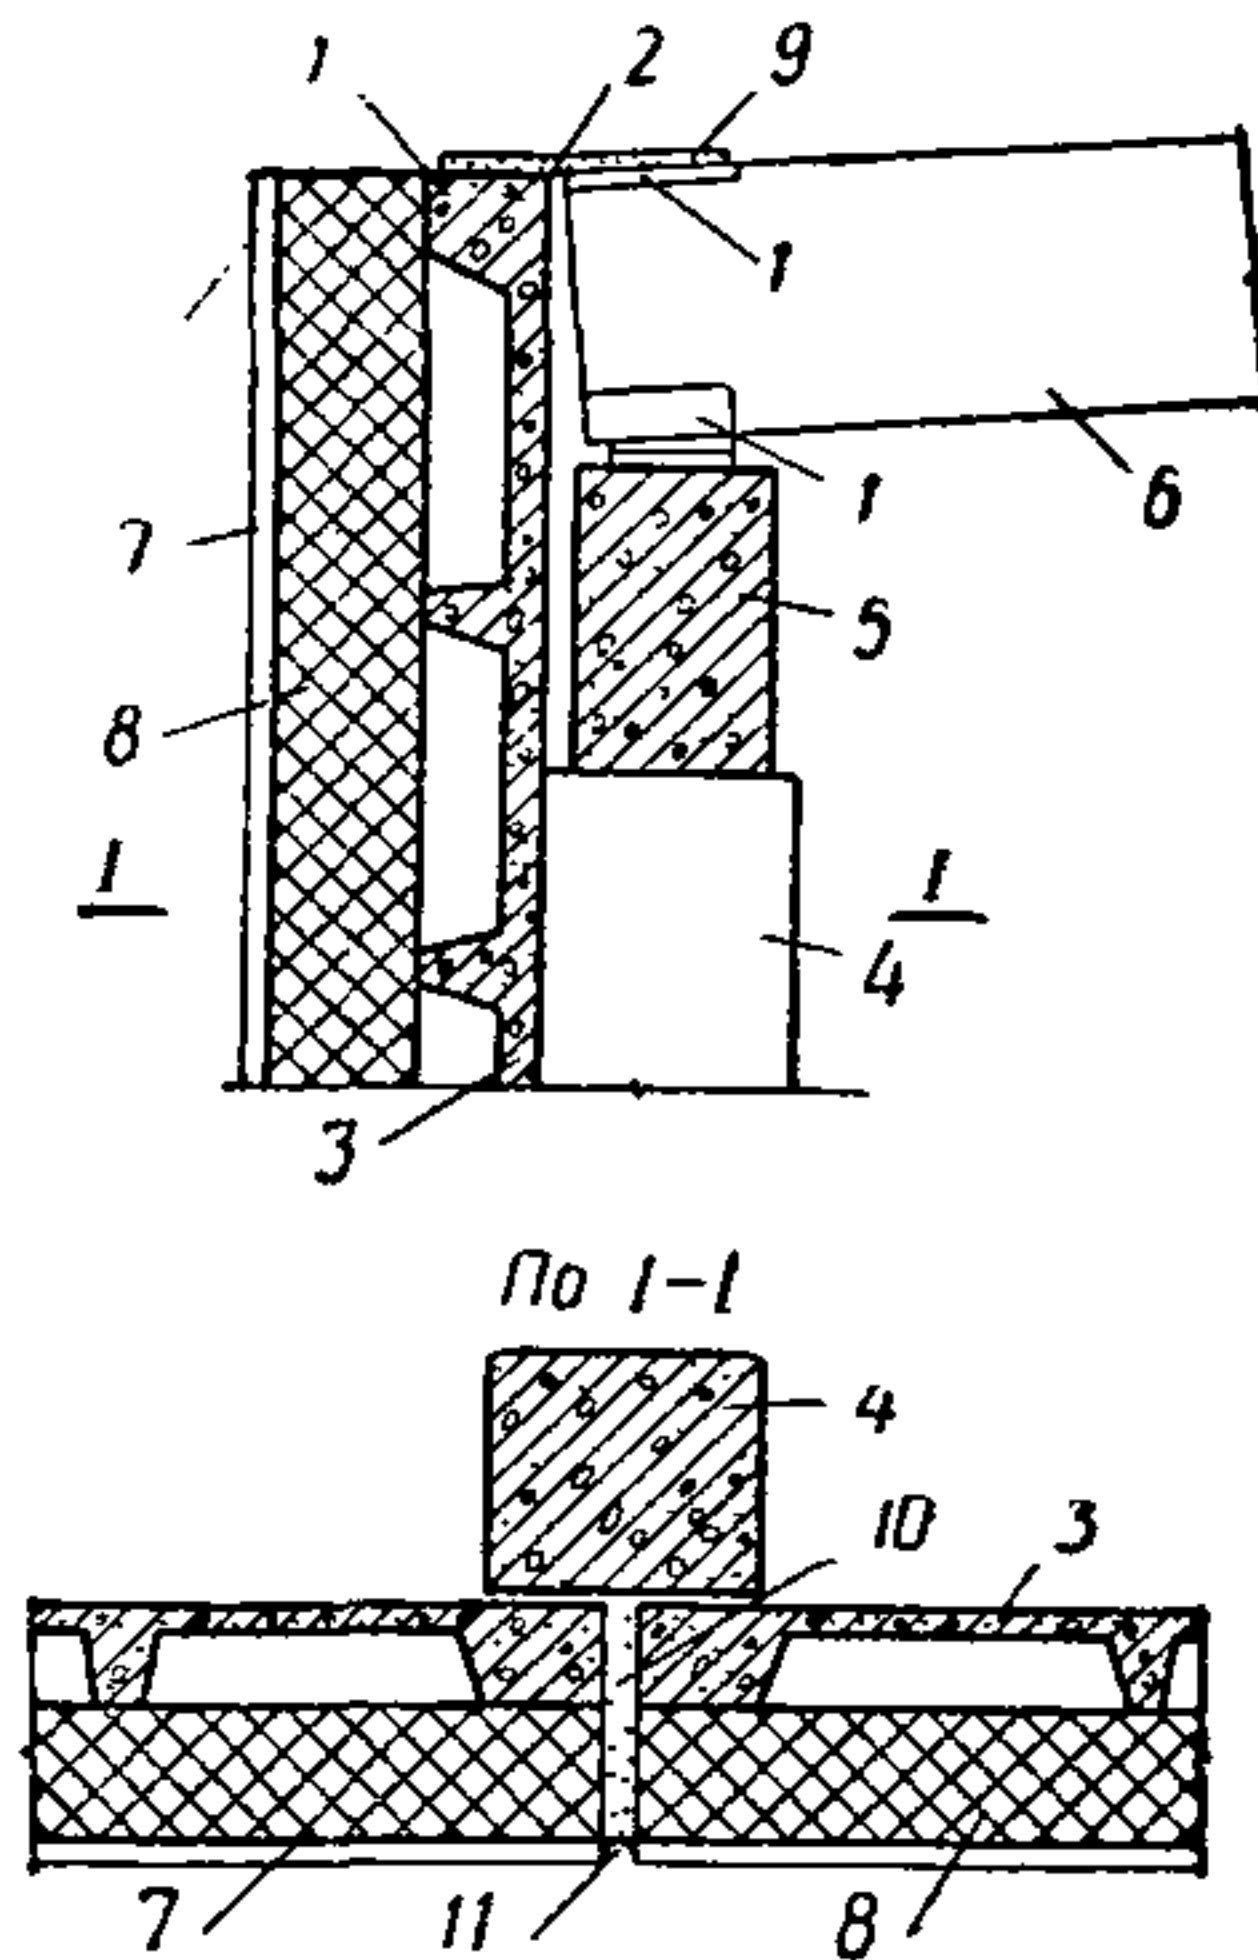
Пример крепления вибропрокатных железобетонных панелей
